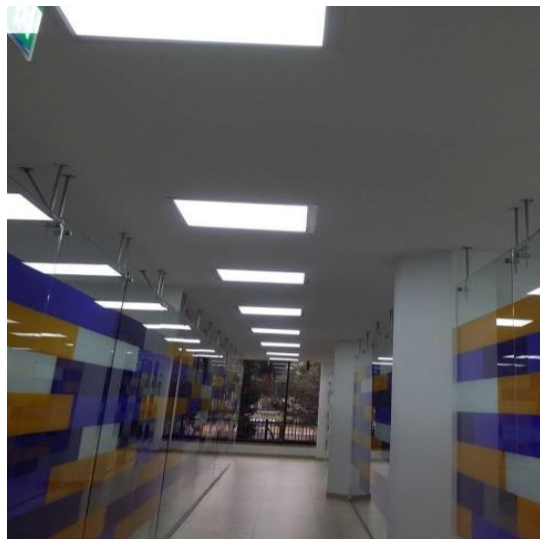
Suministro e instalación de luminaria tipo led de 40 W
